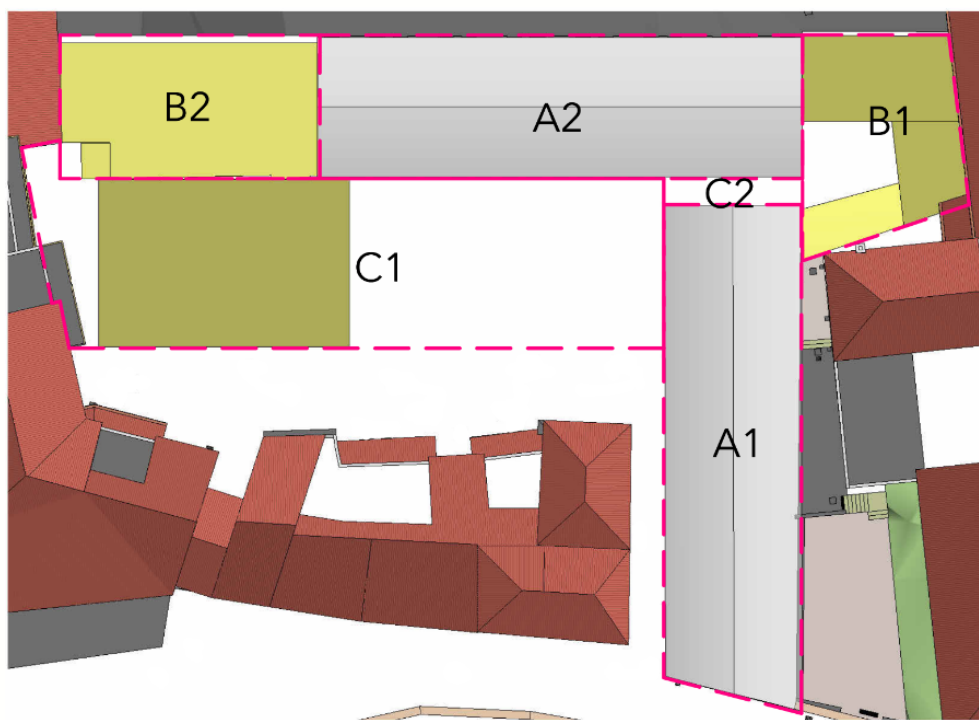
Planimetria dell'ambito interessato dal Piano di Recupero, con individuazione dei comparti di attuazione.
